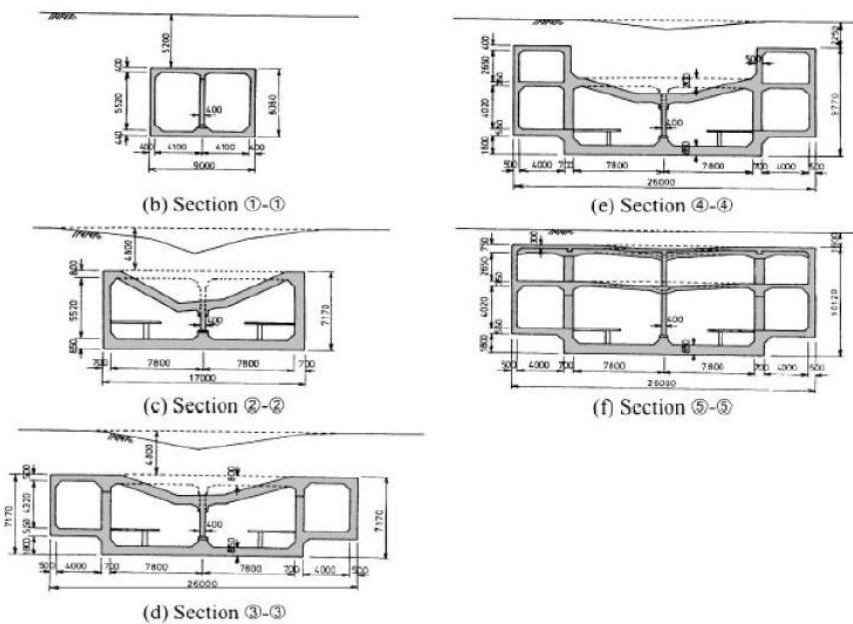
Estação do metro de Dakai. Vista da secção transversal. [Pitilakis, et al, 2011]
